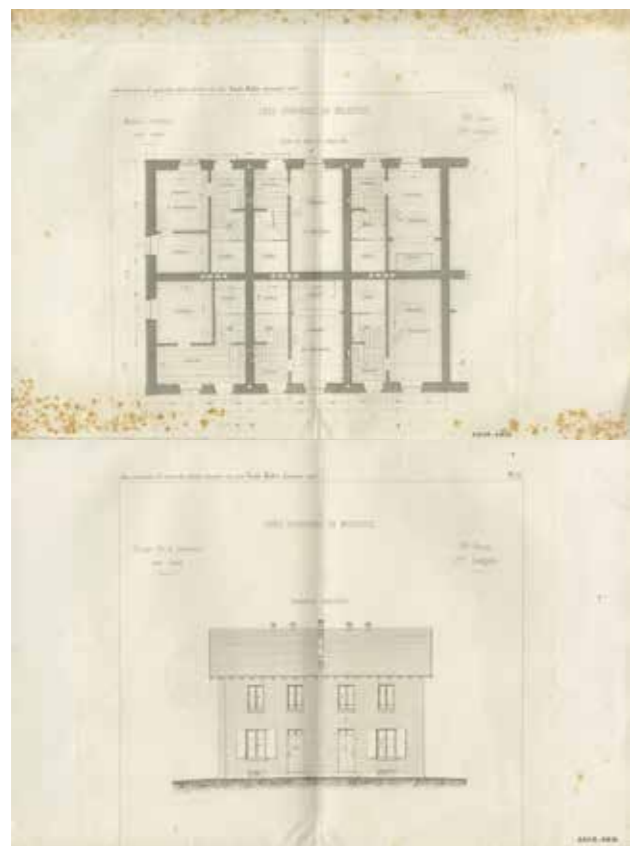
Cités Ouvrières de Mullhouse, por Emile Muller, ingeniero civil. Planta y Alzado.
